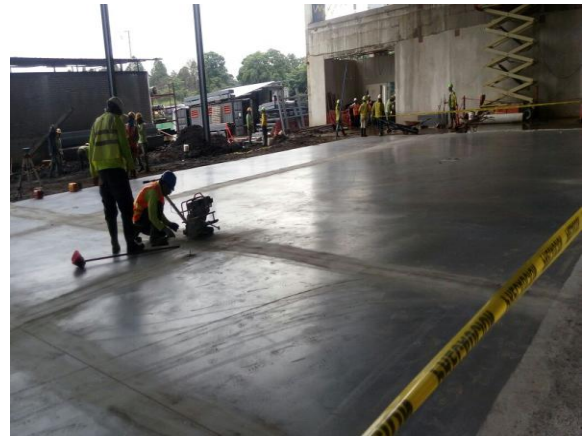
Detallado de contrapiso, corte de juntas y pulido con helicóptero.
